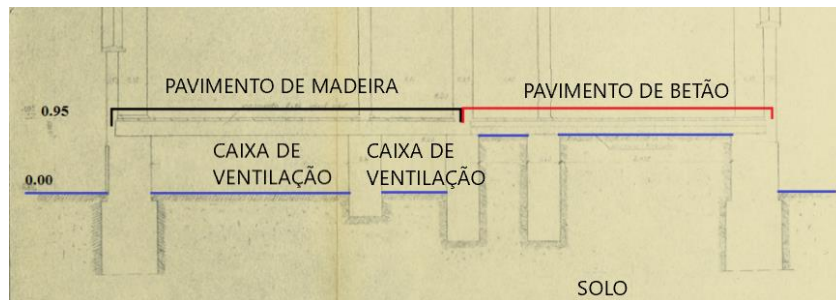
17 - Corte dos pavimentos, com indicação da caixa de ventilação (adaptado de Milošević, 2019).
